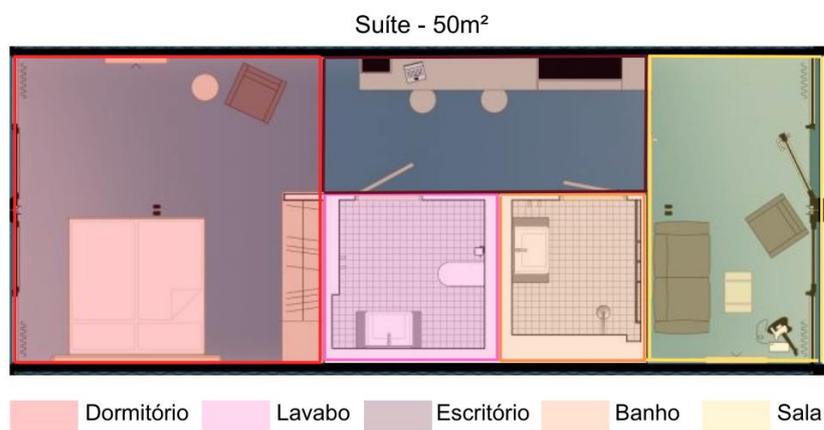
Setorização / Planta baixa suíte. Alterado pelo autor.
